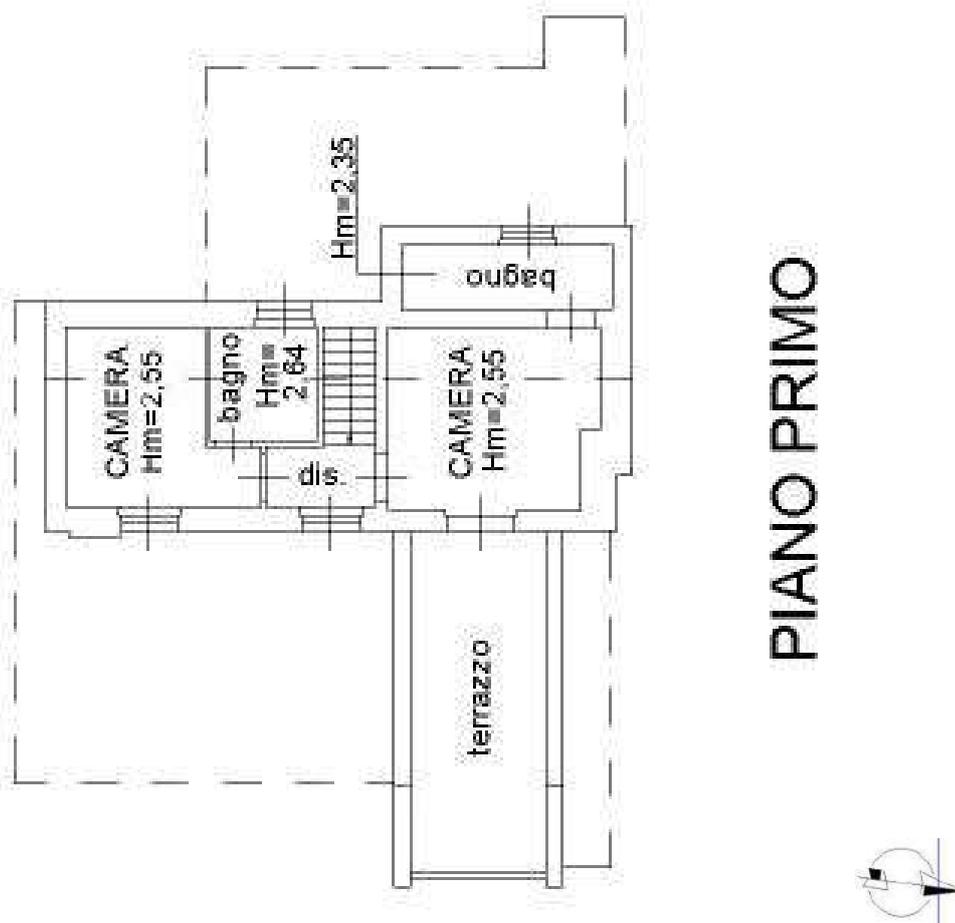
Stralcio planimetria VILLA – Fg. 9, particella 246 sub.4 – PIANO PRIMO
